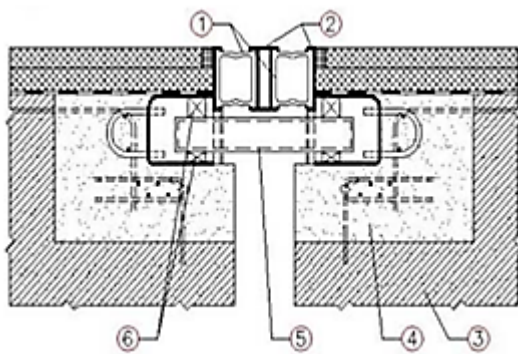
Übergangskonstruktion für große Dilatationen: (1) Kautschukprofil, (2) Stahlprofil, (3) Stahlbetonkonstruktion, (4) Ortbeton, (5) Stahlprofil, (6) Gleitlager<sup>53</sup>
